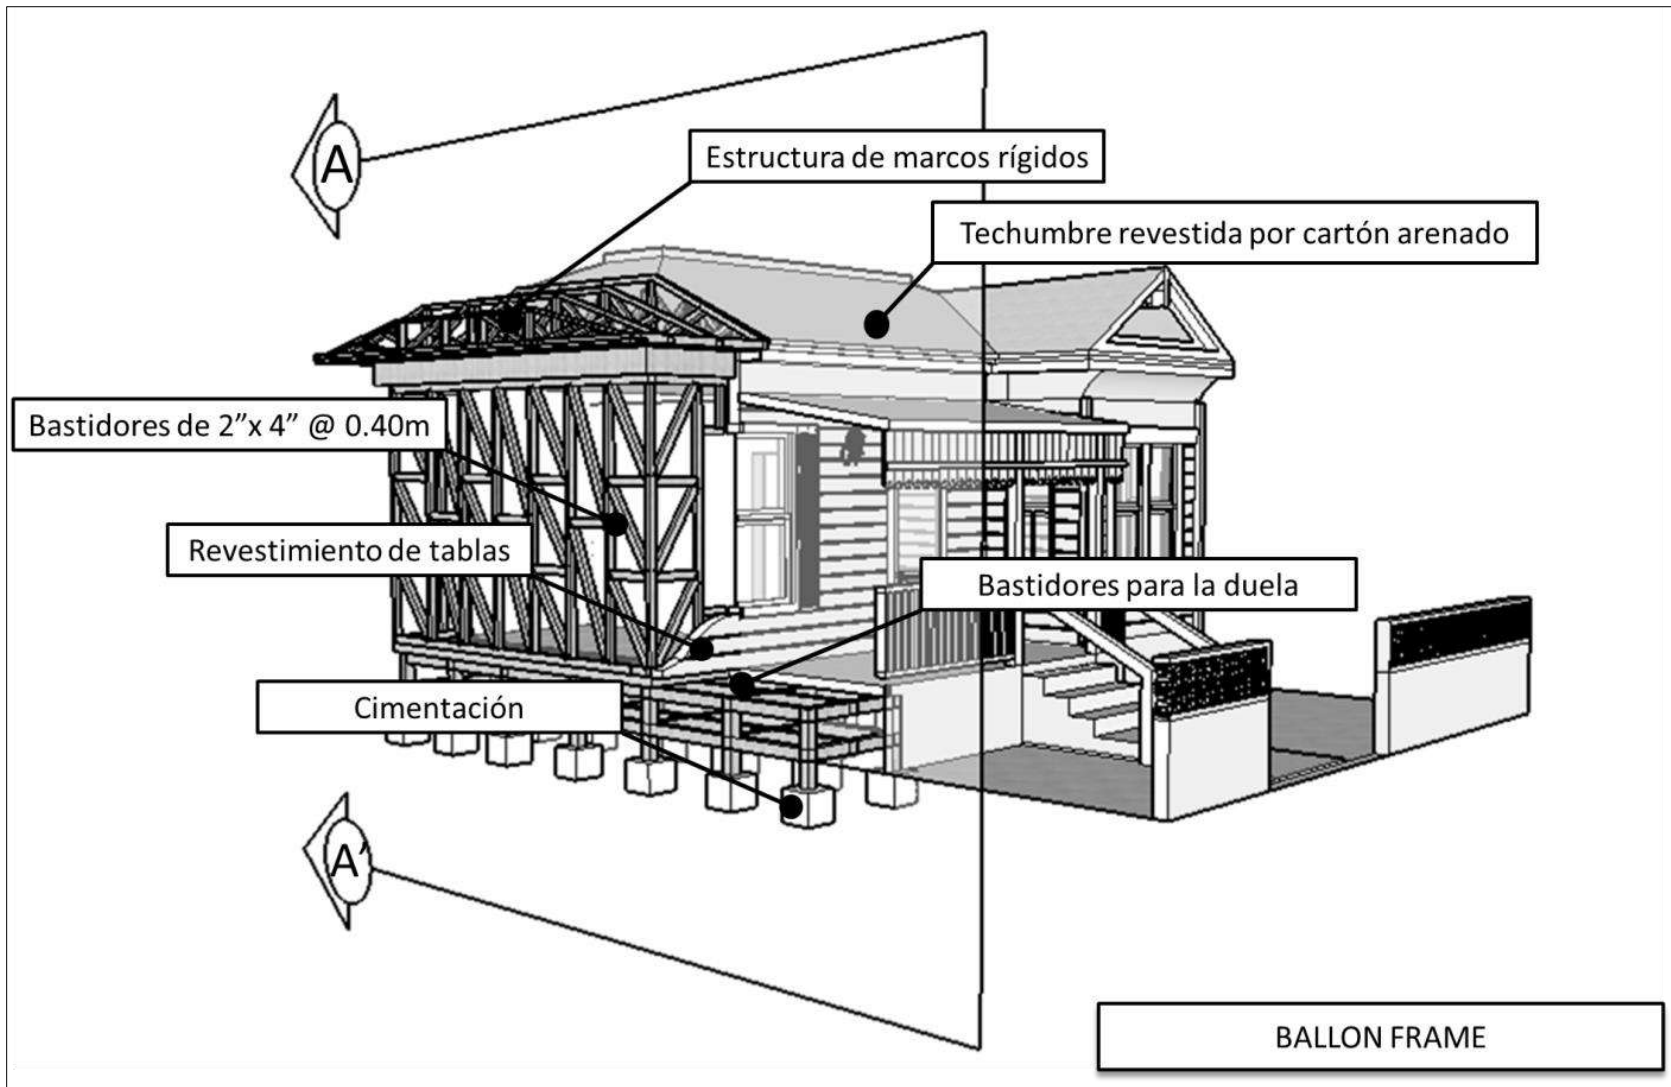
Diagrama esquemático sobre el sistema constructivo denominado ballon frame
